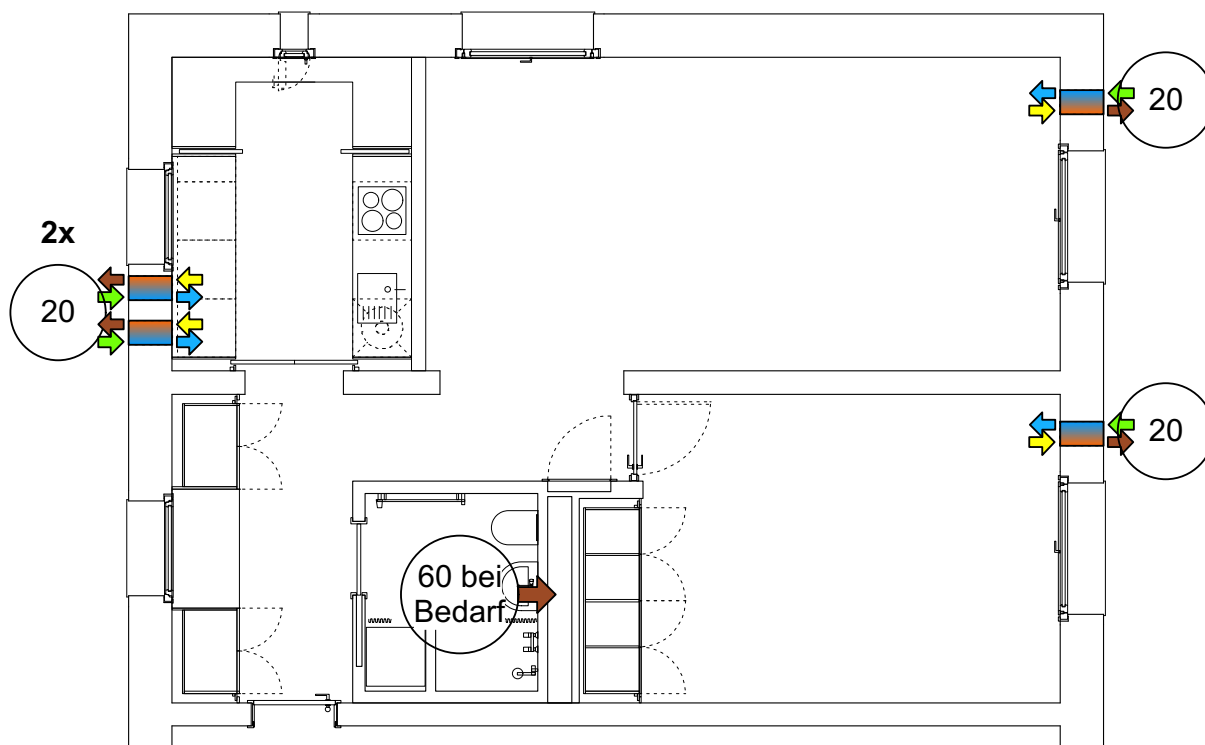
, Grundriss Schema Szenario C: Dezentrale Einzelraumlüfter mit Wärmerückgewinnung (WRG) + Badabluft, Quelle: Florian Nagler Architekten / Tilmann Jarmer, TU München [Jarmer 2023]
